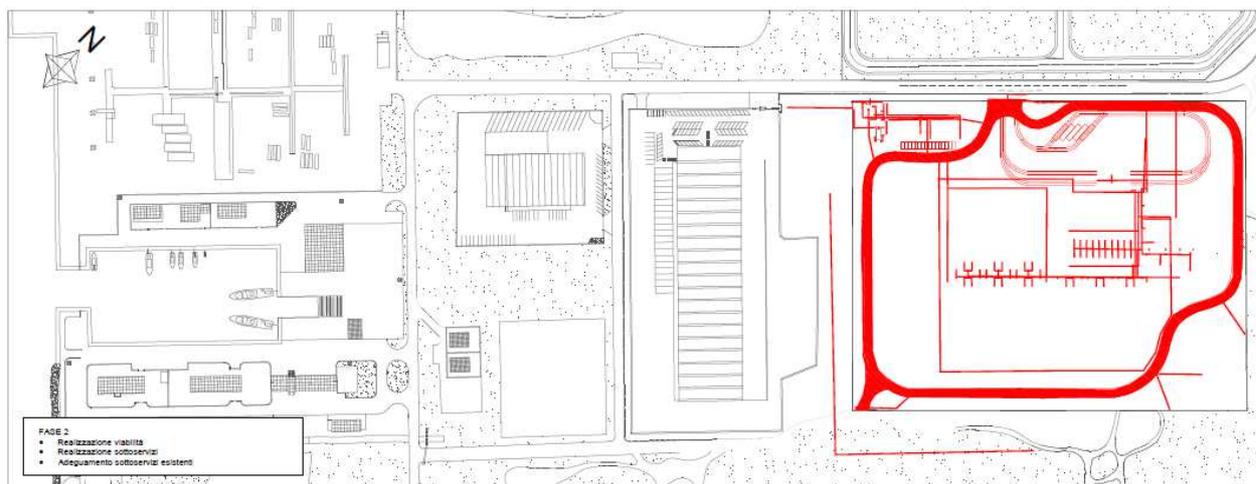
Fase 2. Area oggetto delle lavorazioni previste.
